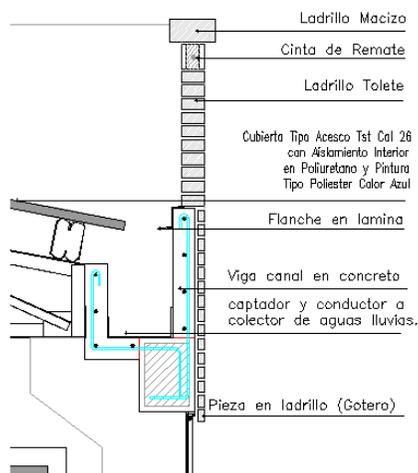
Bajantes de aguas lluvias a la vista y Detalle constructivo viga canal captadora
